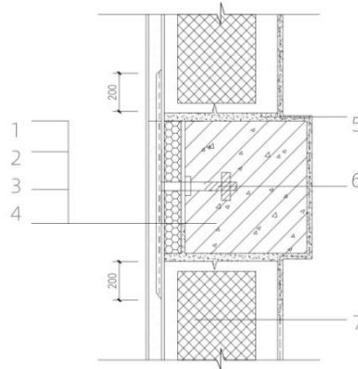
自保温墙体与混凝土柱、梁的连接部位构造
